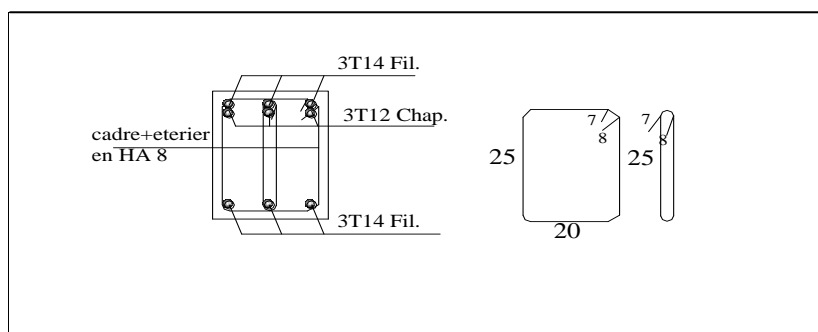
Ferrailage en travée d'une poutre principale PP2 sur appuis.
